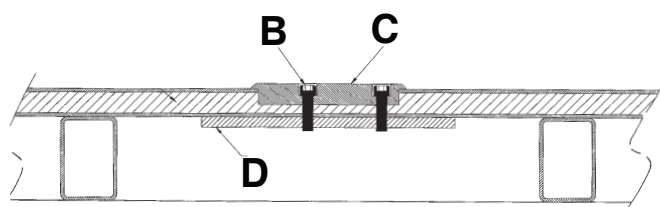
Anclaje de la placa de pared en las aberturas empotradas
